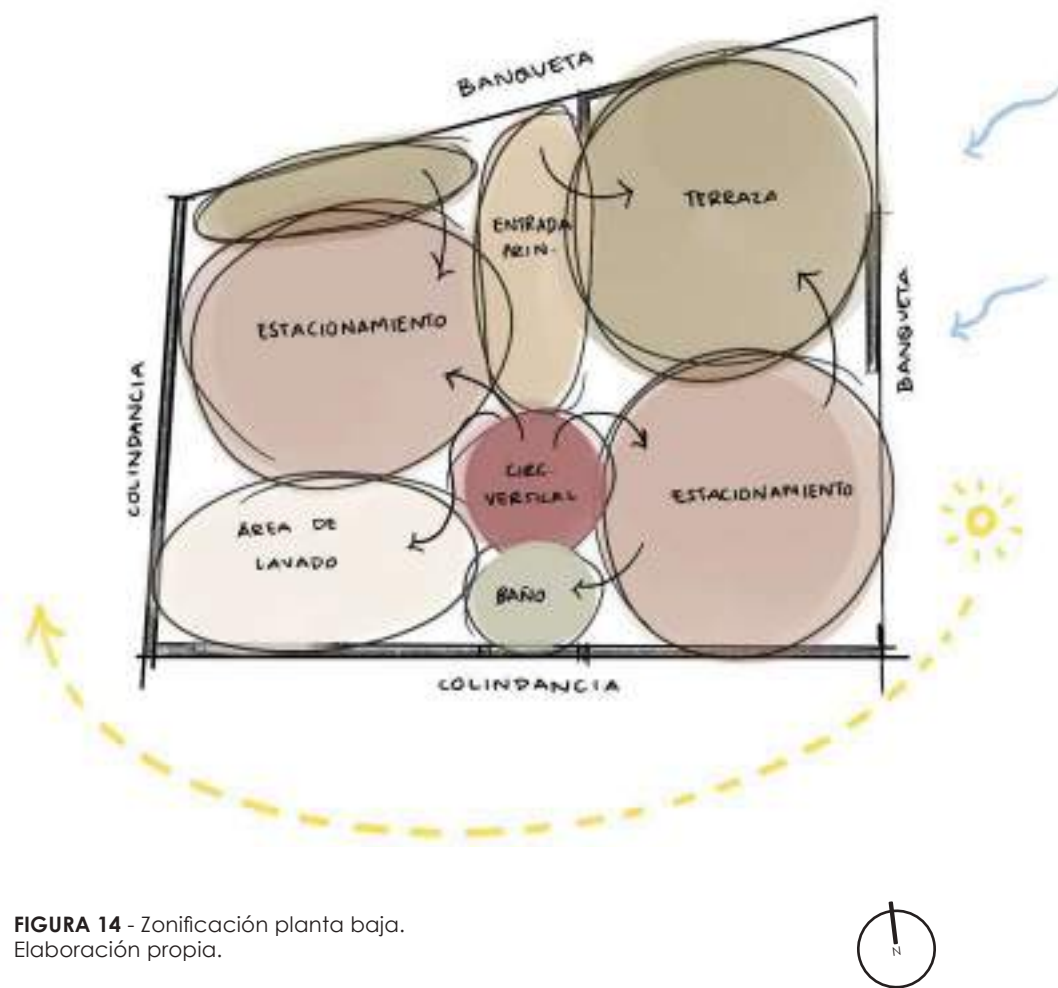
Zonificación planta baja. Elaboración propia.
